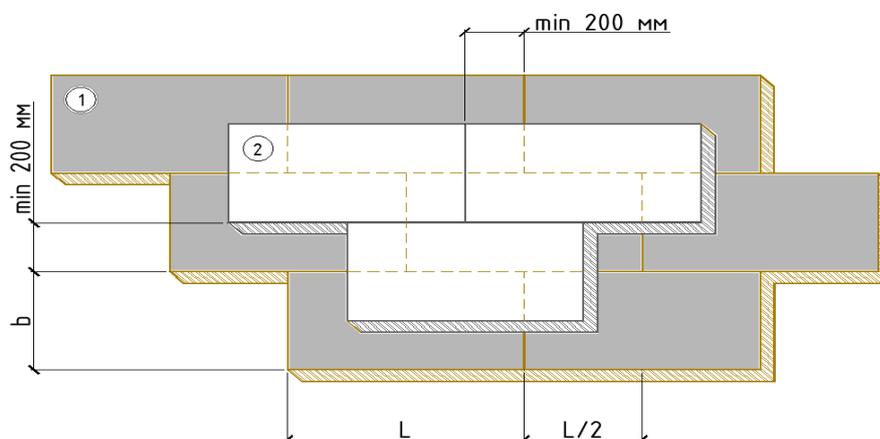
Смещение плит верхнего и нижнего слоев при укладке.
